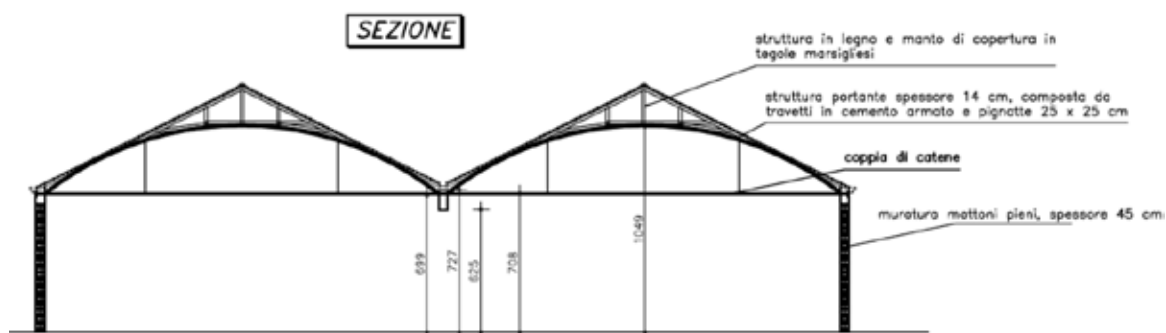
Sezione trasversale schematica tipica delle strutture del complesso
